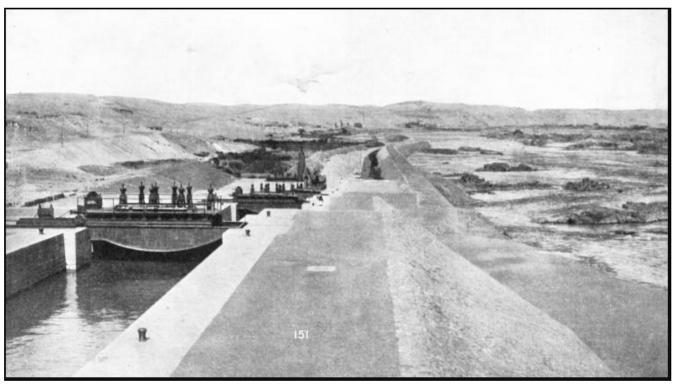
صورة تبين مدى ارتفاع البوابات المتساندة
